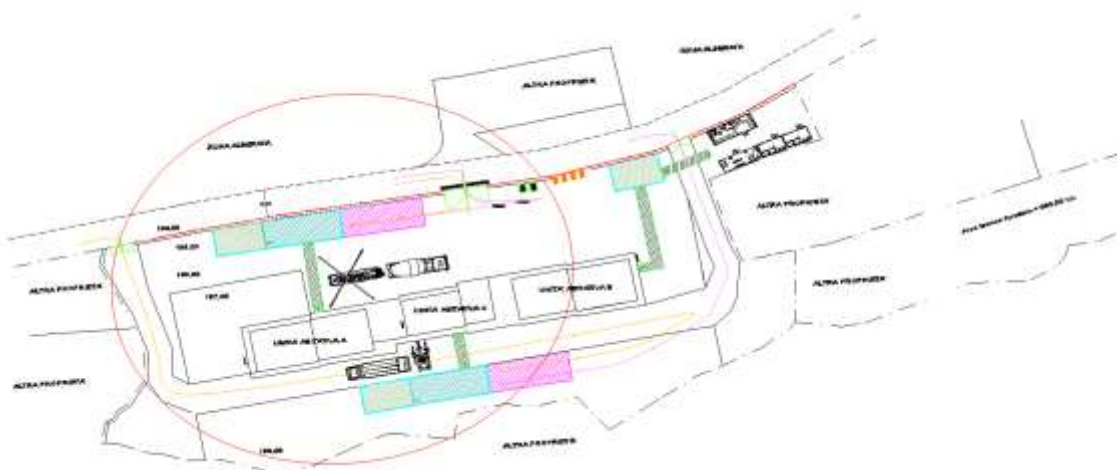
Stralcio del layout di cantiere con indicazioni dei mezzi che lavorano contemporaneamente in cantiere
